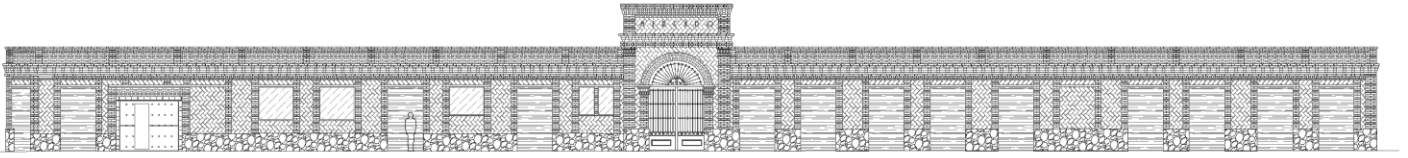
Fachada Principal (calle Guadalupe Victoria)
